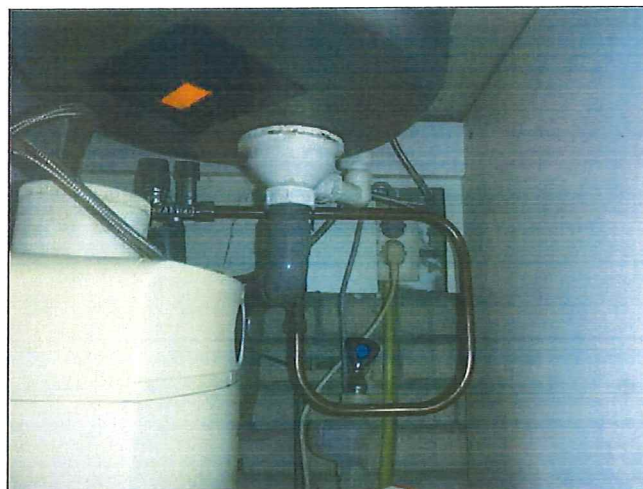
Keuken: Boiler (Niet asbestverdacht)
